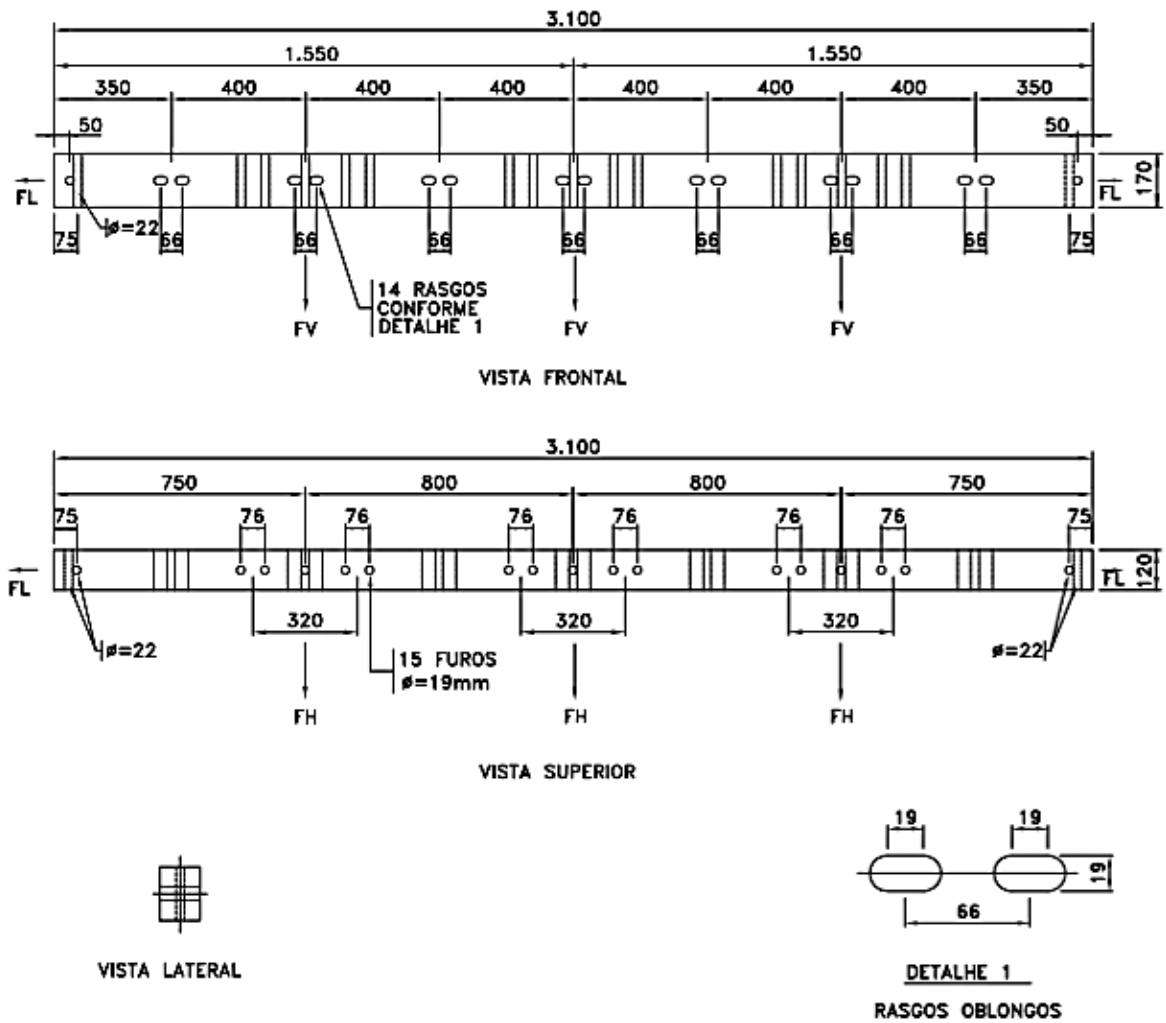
Viga de concreto armado 120x170x3.100mm montagem vertical e horizontal
